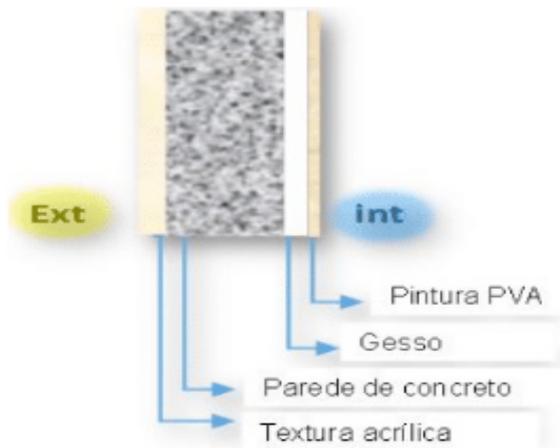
Sistema construtivo do apartamento do estudo de caso 1.
